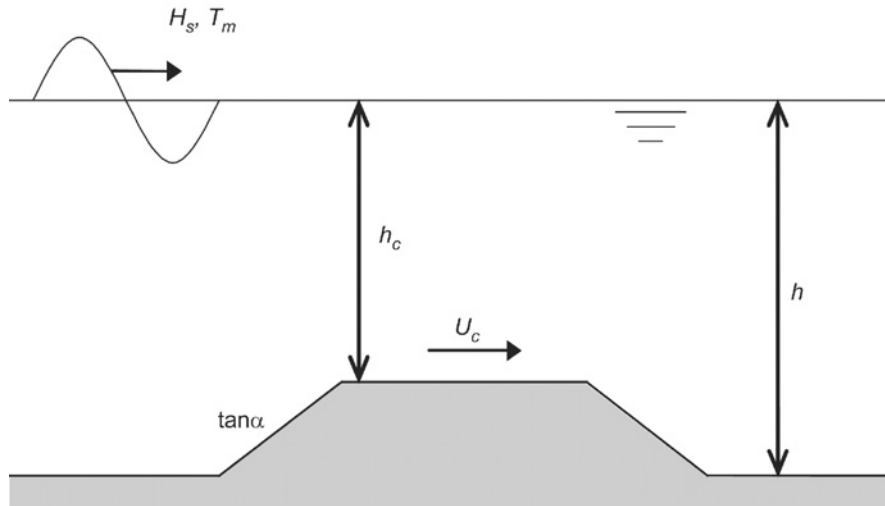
Schéma explicatif d'un ouvrage de fond
